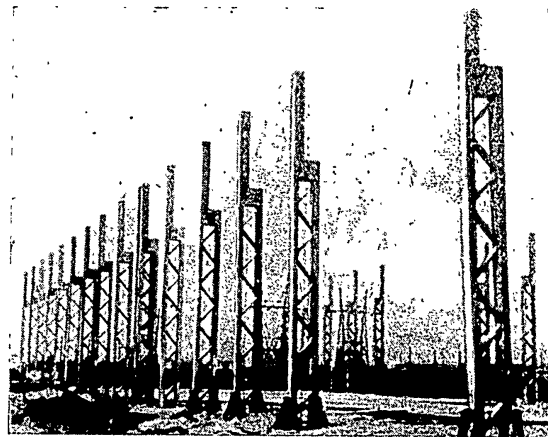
Двухветвяные колонны с напряженно армированной решеткой.
